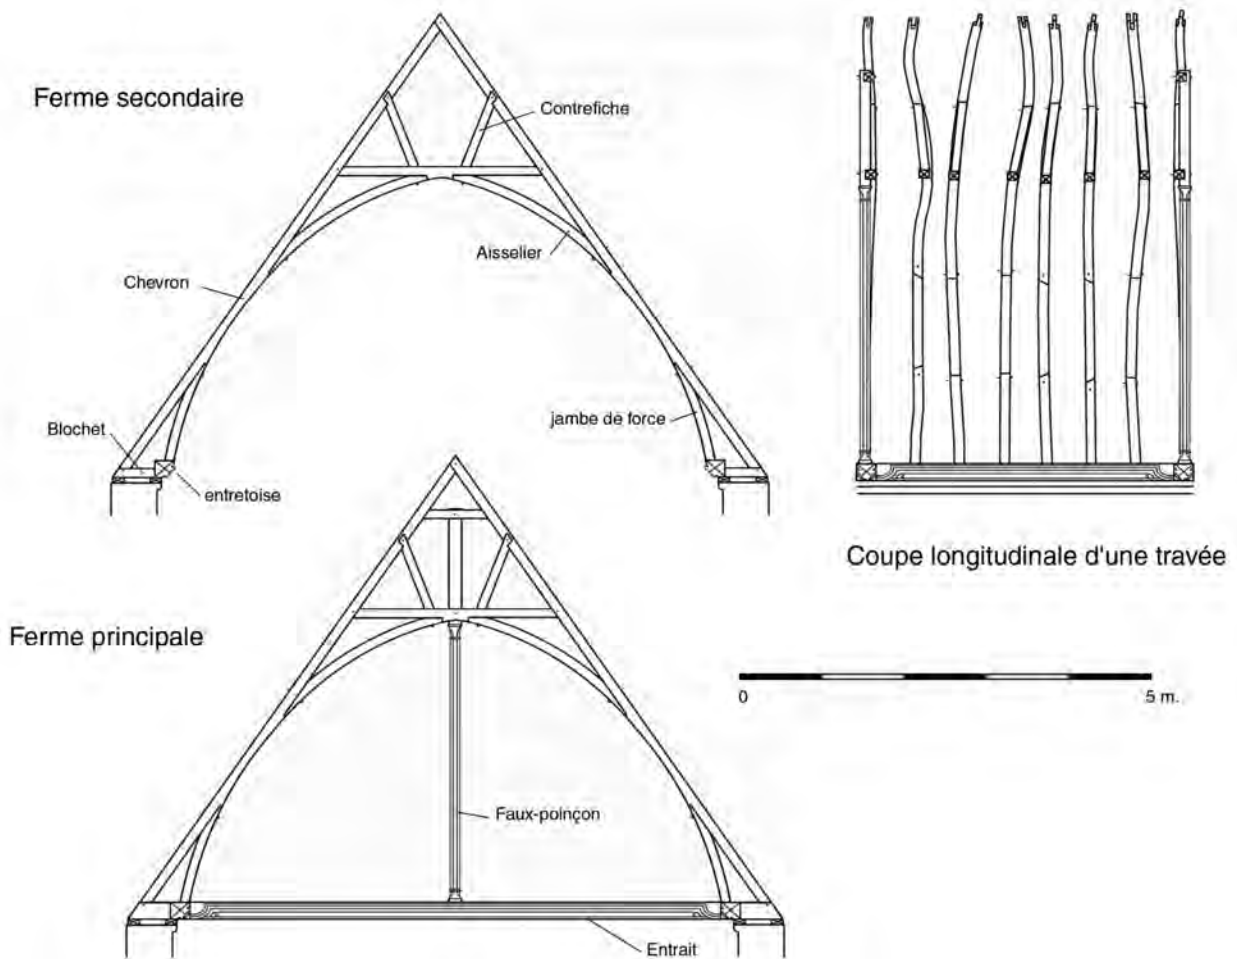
Charpente de la salle haute : fermes et coupe longitudinale d'une travée (1226d).
